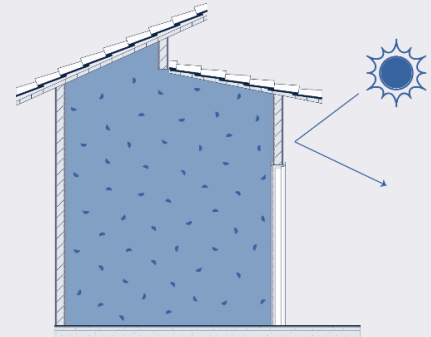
Estratégia de Aberturas Pontuais: Fachada, Zenital, Telhas Translúcidas
